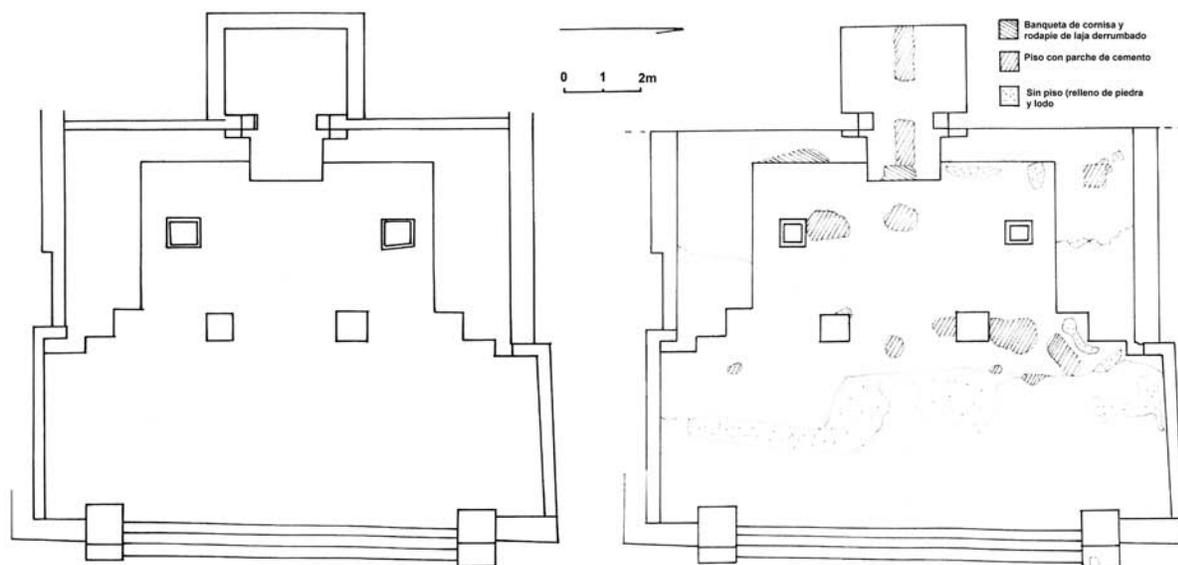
Juego de pelota 2, templo oriente. Izq.: planta estructural. Der.: plano de deterioro del edificio antes de intervenirlo (dibujos del autor)
